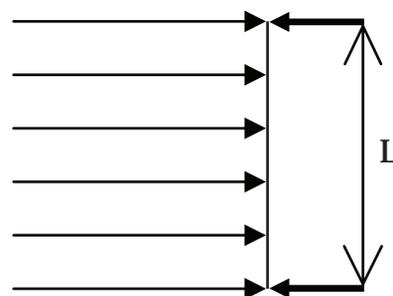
, Таблица 2. Нагрузки на стеновые панели с минераловатным утеплителем. Схема нагружения — однопролетная балка.
